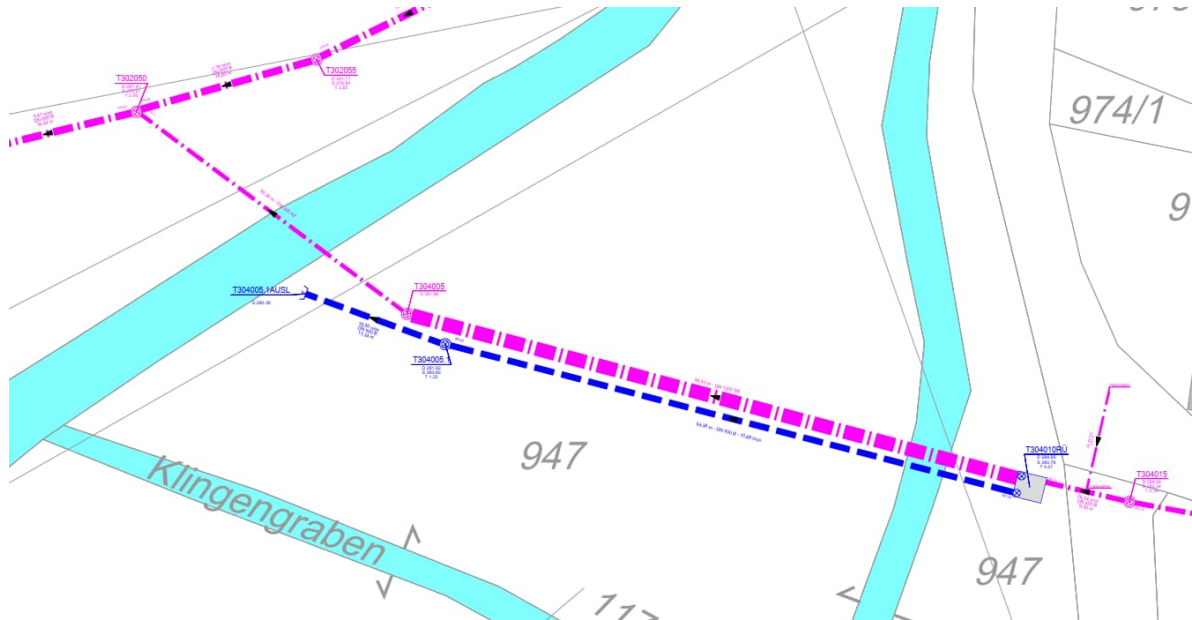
Lageplan SRK 3 Am Brunnhölzlein
